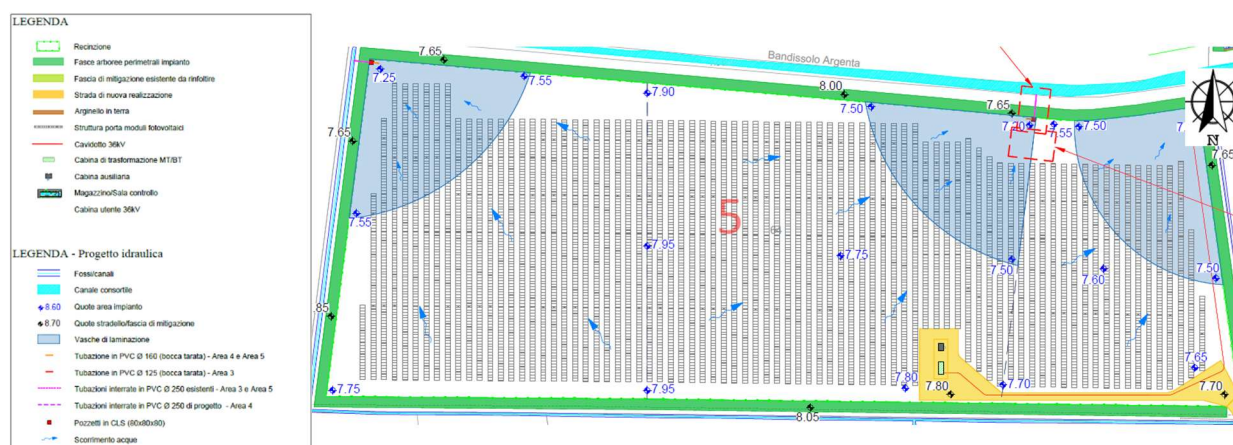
Planimetria area 5 con individuazione scarichi e vasche di laminazione (stralcio Tav. 43B)
